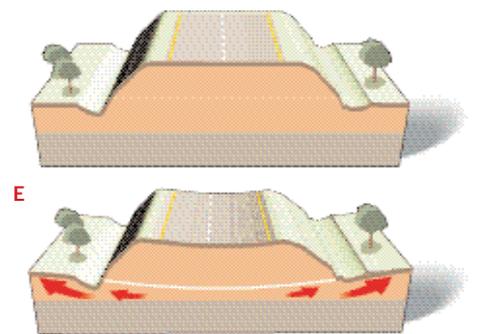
Figura E: stato limite ultimo per estrusione del terreno di fondazione.
